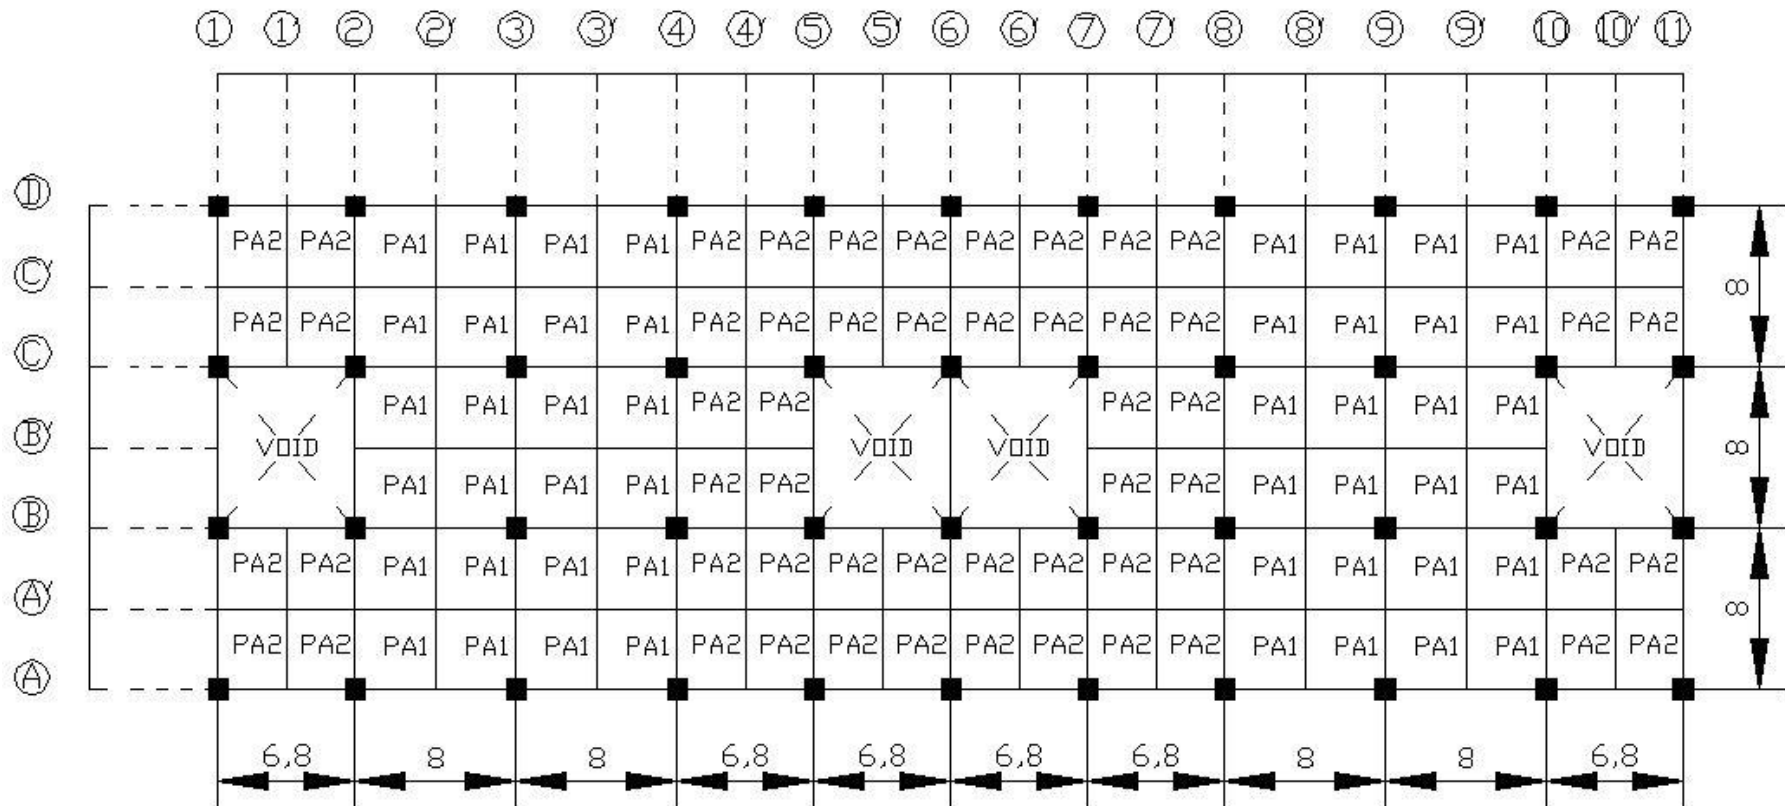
Denah Kolom Lantai 2-10
